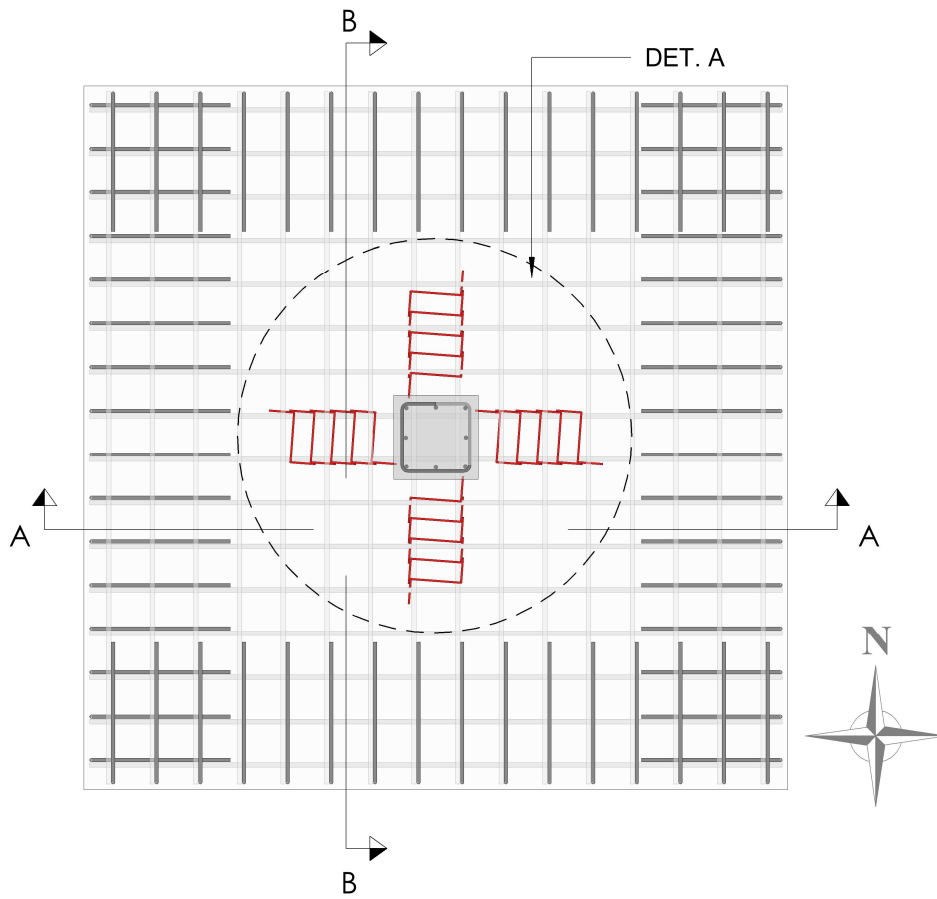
Vista em planta da montagem da armadura de cisalhamento
